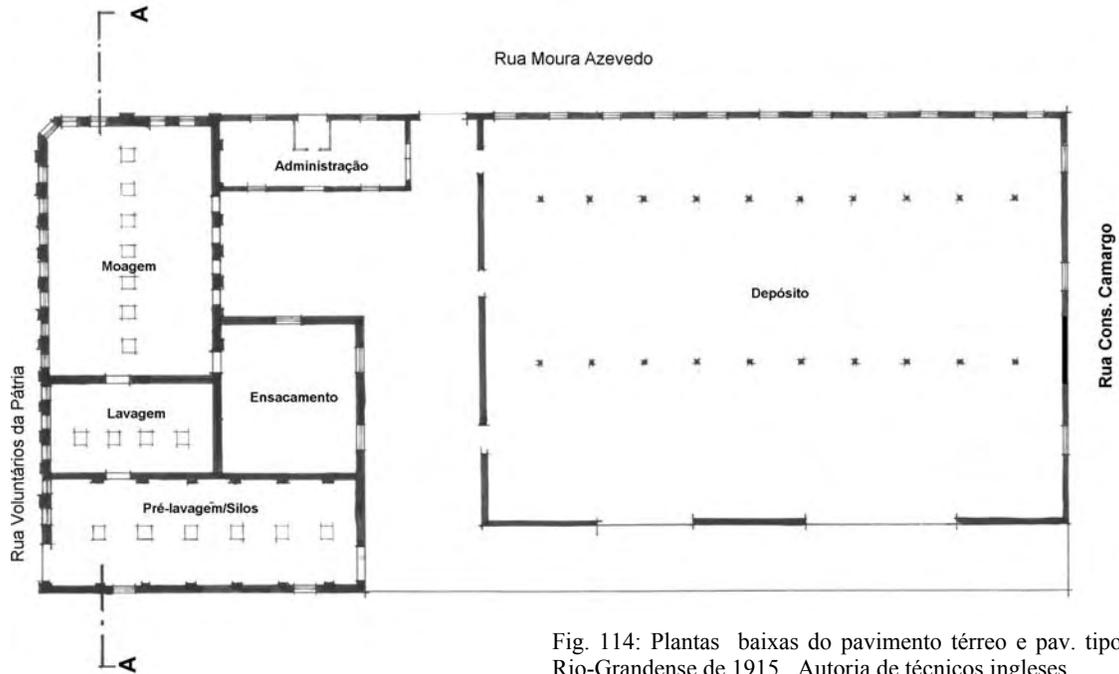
Plantas baixas do pavimento térreo e pav. tipo do Moinho Rio-Grandense de 1915. Autoria de técnicos ingleses.
